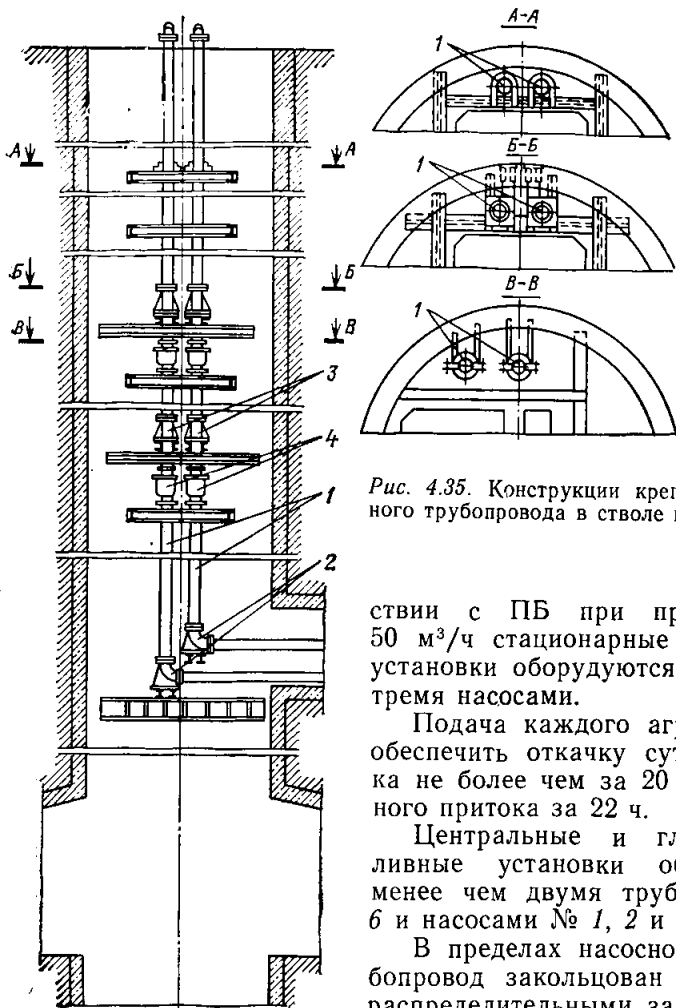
Конструкции крепления водоотливного трубопровода в стволе шахты
